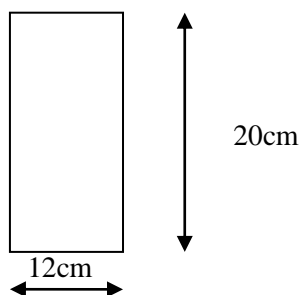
Coupe schématique de la poutrelle (appuis)
